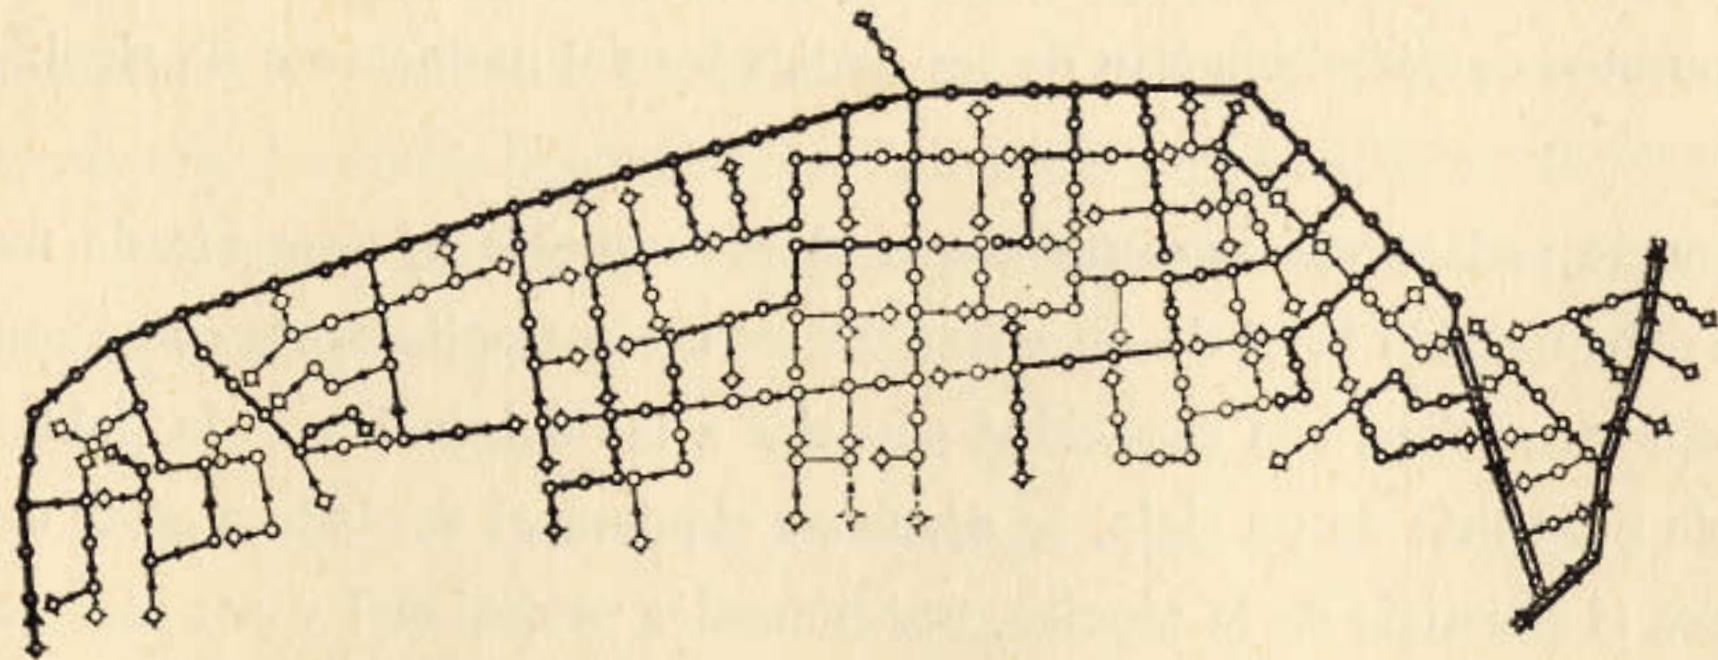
Red de alcantarillado en el ensanche Norte de Murcia.
